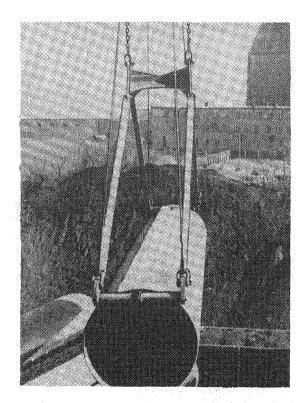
Крановый автоматический захват для труб большого диаметра конструкции Калининградского порта
